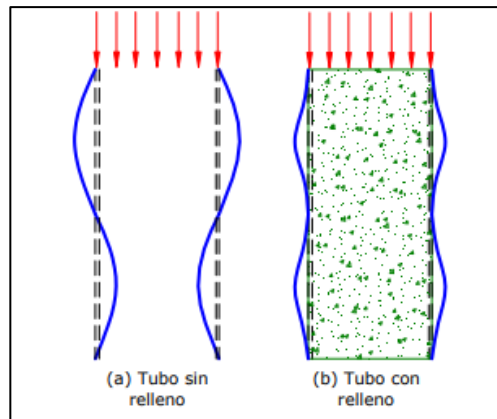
Vista lateral de la deformada por pandeo local de un tubo (a) sin relleno y (b) compuesto relleno de concreto
